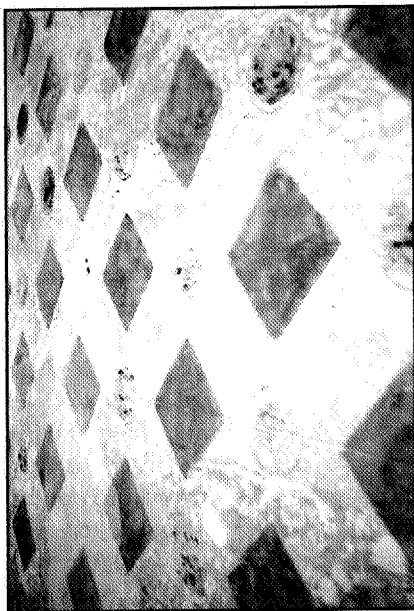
Sevilla. Iglesia de Santa María la Blanca. Fachada sur. Detalle (durante la restauración).
